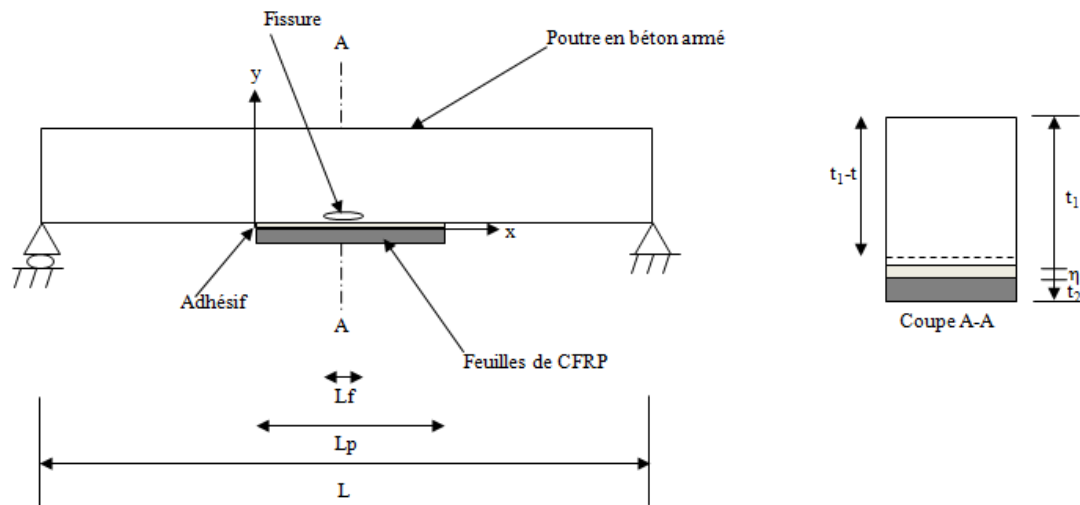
Poutre simplement appuyée fissurée et renforcée par CFRP.
